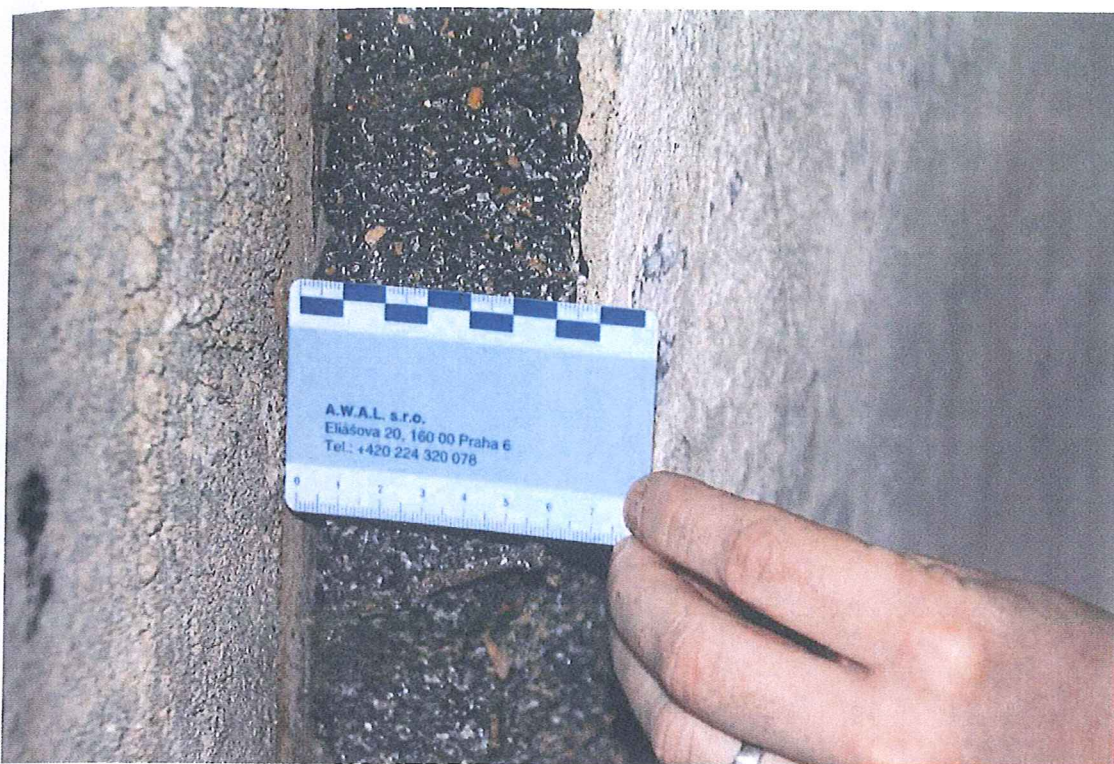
Korkolitu se pohybuje v různých tloušťkách nejčastěji od 60 – 120mm
